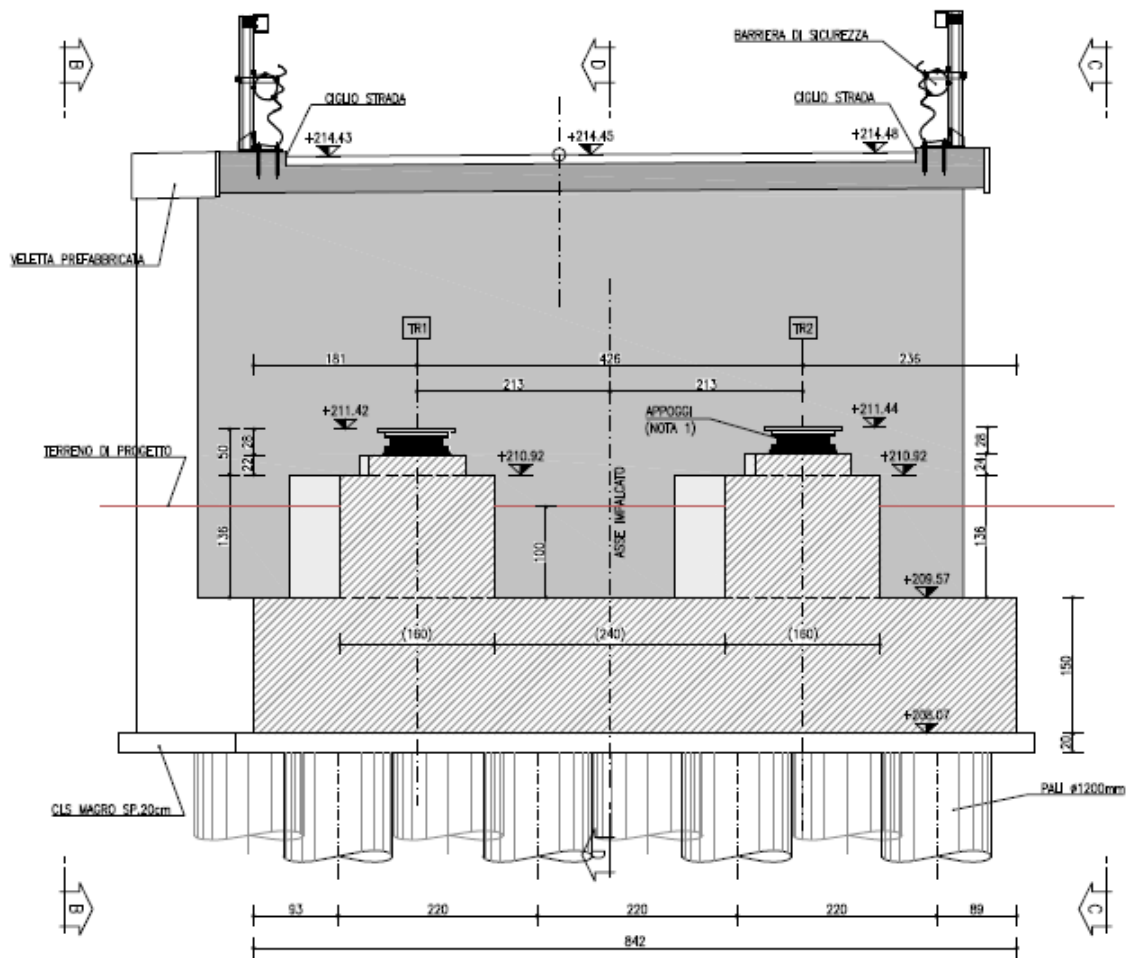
Spalla 2 – carpenteria elevazioni
